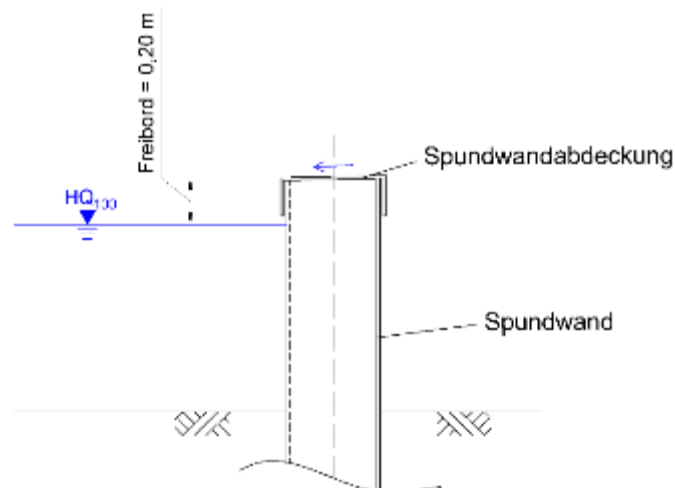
Regelquerschnitt für die oben genannten Maßnahmen
